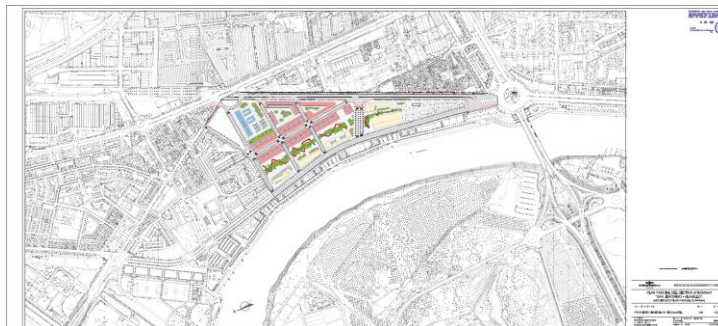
Plan de masse du *plan parcial API-DMN-01* de 2007¹¹³
